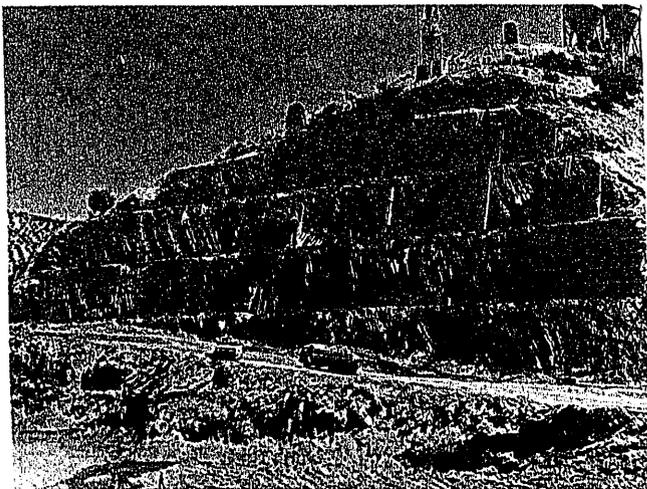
Vista general de la excavación del canal Tajo-Segura.
